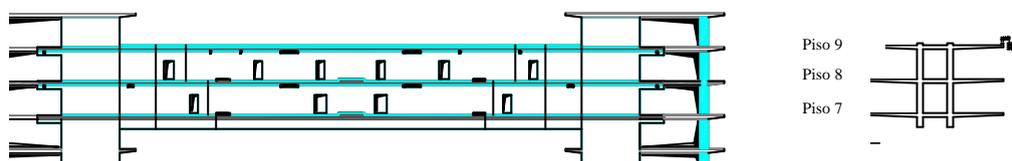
Alçado e corte transversal da “ponte da Administração”
